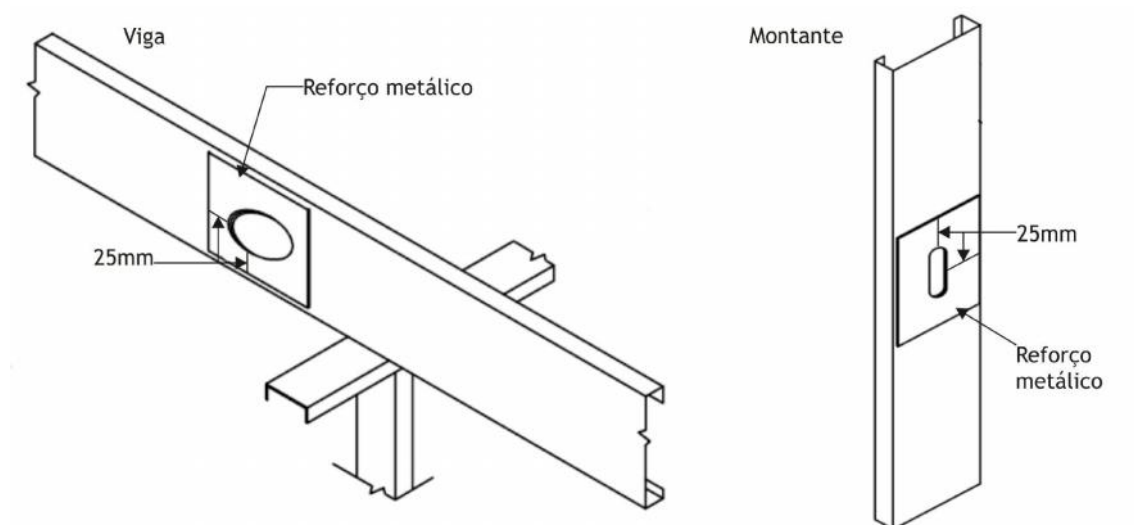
Abertura com reforço, viga e montante. Adaptado de: ConsulSteel, 2002.
